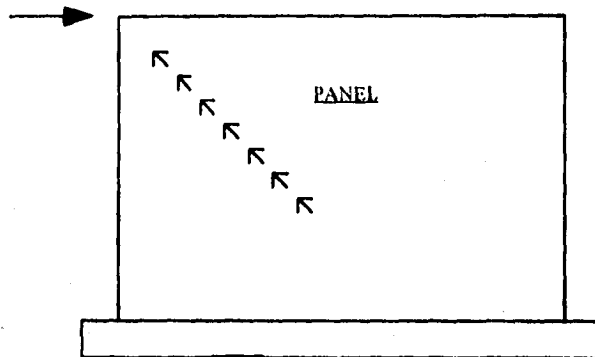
Detalle de la primera grieta en el muro.
